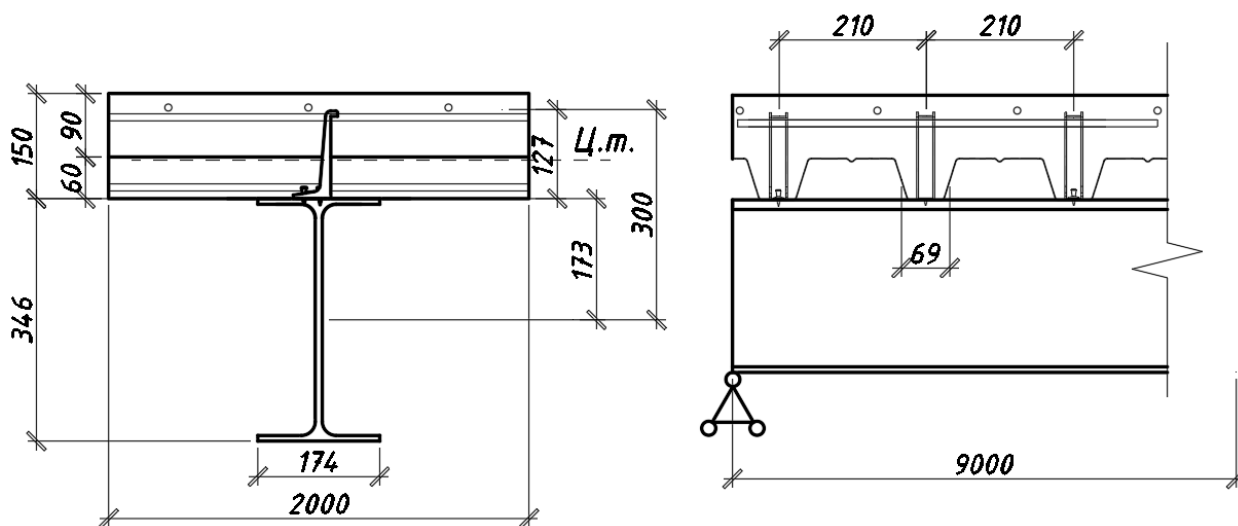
Характеристики расчетного сечения сталежелезобетонного перекрытия
